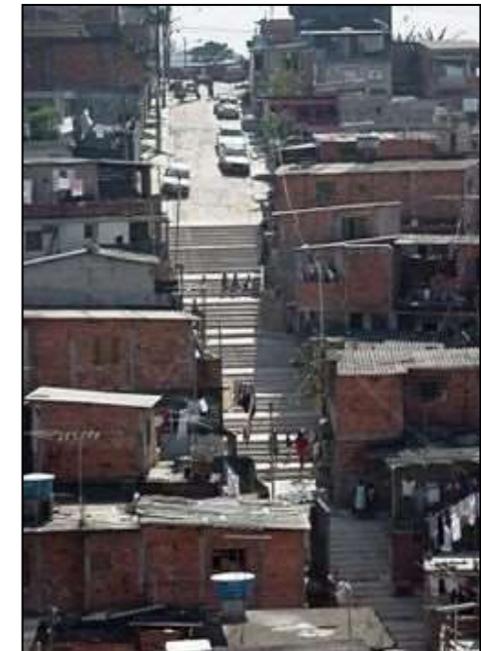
Favelas Localizadas en Río de Janeiro, Brasil, en la foto se observa la intervención de una calle aledaña a las Viviendas por medio de escalinatas de concreto dispuestas según la topografía del sitio.
